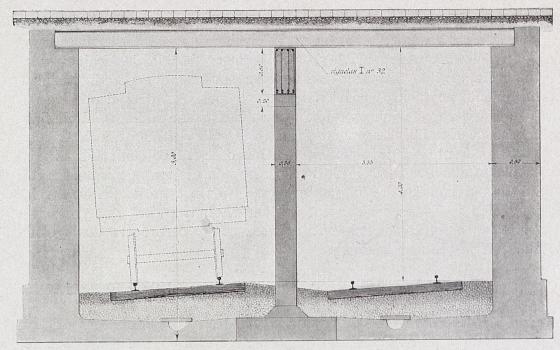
Túnel con techo plano. — Sección trasversal.
